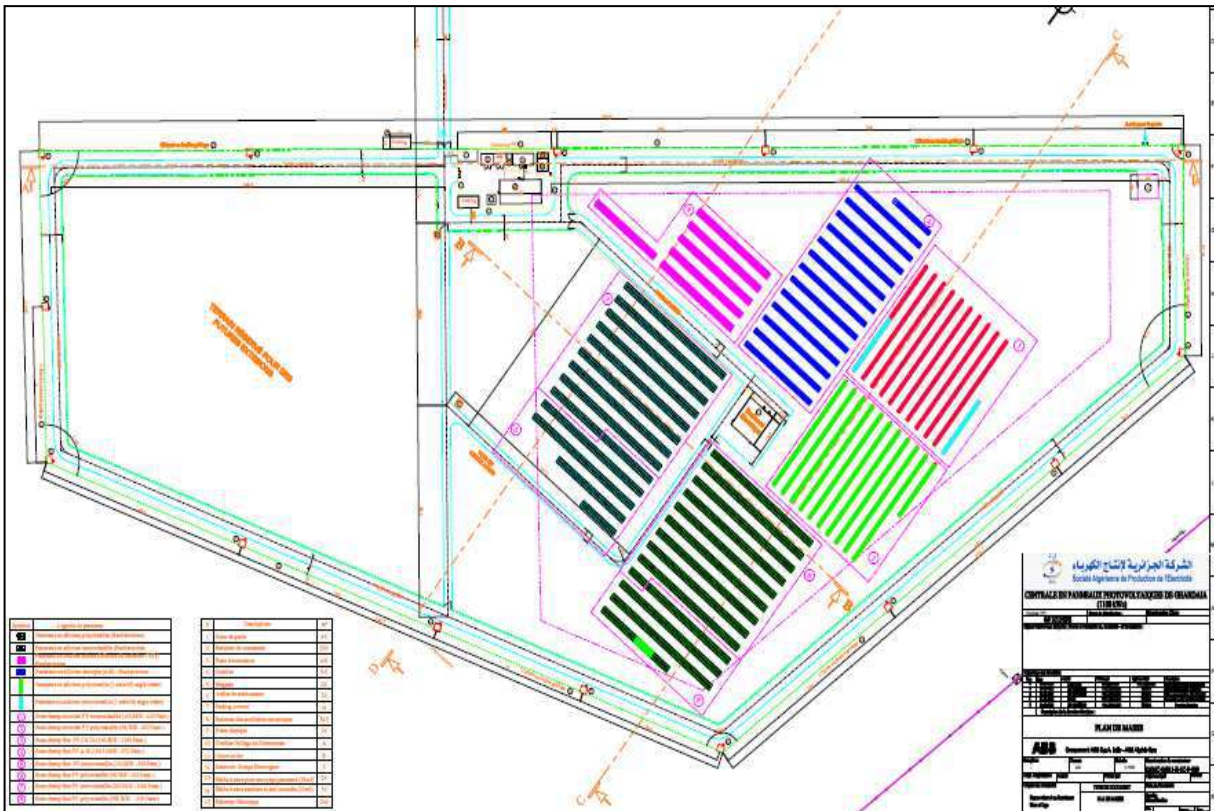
Plan de masse SKTM OUED NECHOU
